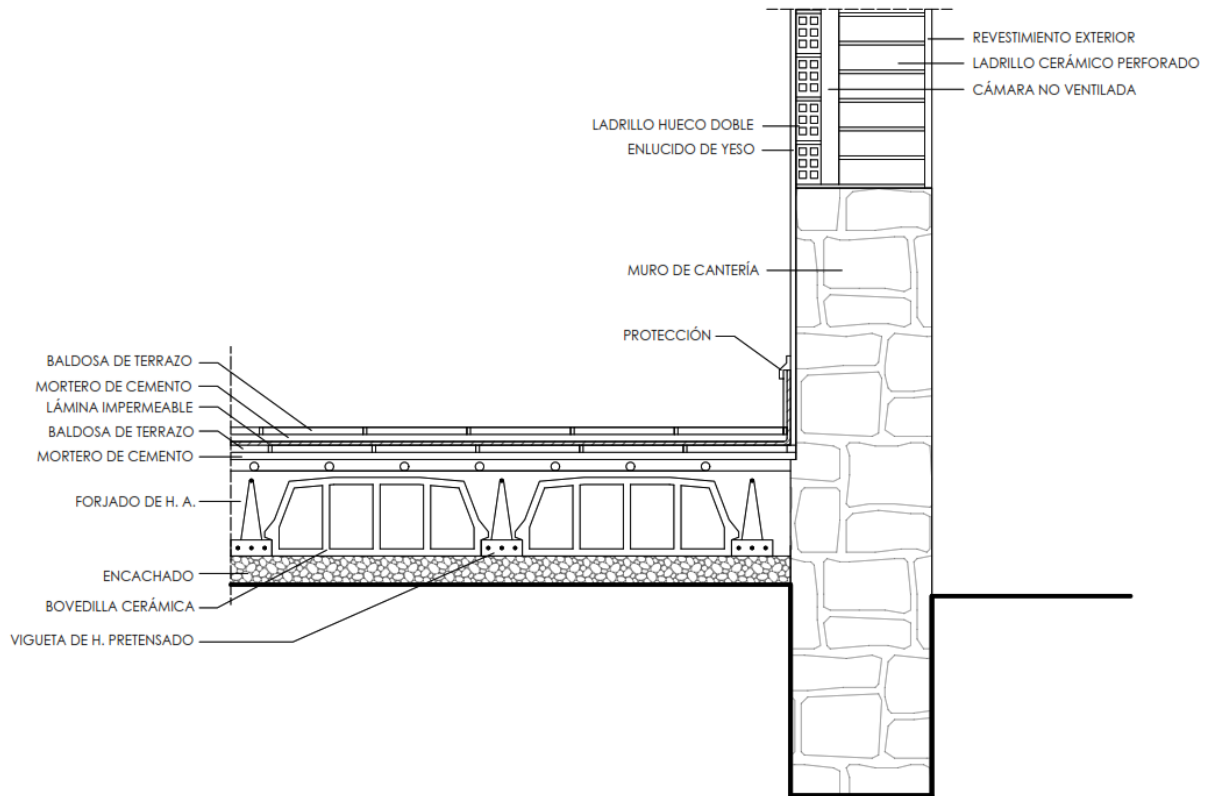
Detalle constructivo vivienda 969, estado reformado
